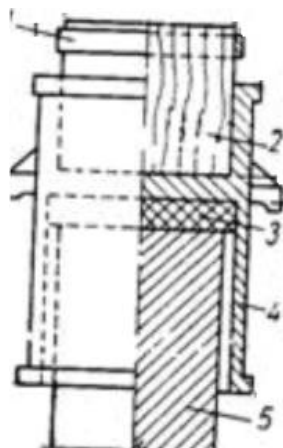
Используемый наголовник для сваи. 1 – бугель; 2 - дубовый вкладыш; 3 - амортизирующая прокладка (мешковина); 4- стальной стакан; 5 – свая
